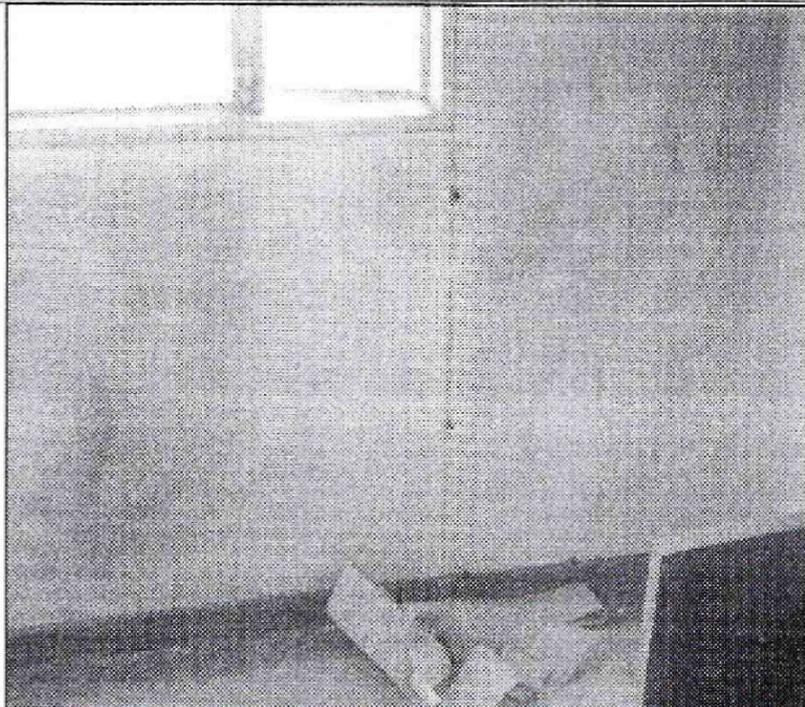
Fisuras de tendencia escalonada observadas en muros de cerramiento del apartamento 502 torre 7, y que son colindantes con el apartamento 501 torre 8, donde al parecer se desarrollan obras de ampliación y/o modificación.
